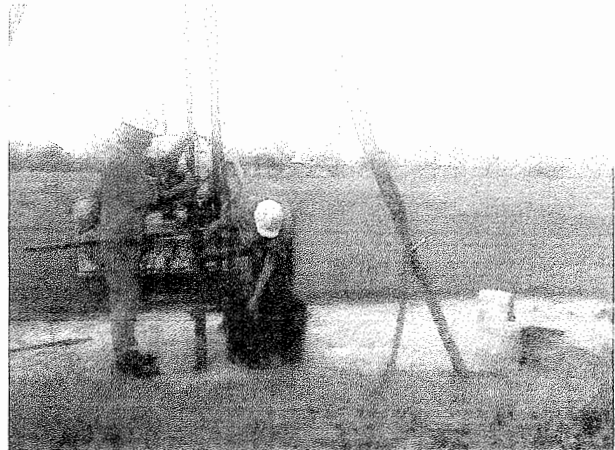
Detalhe da operação da lavagem para encontrar a cota de amostragem.
